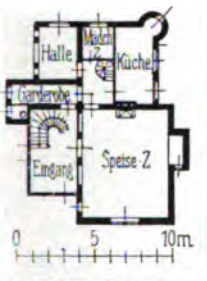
190 Grundrisse zu Abbildung 187.
